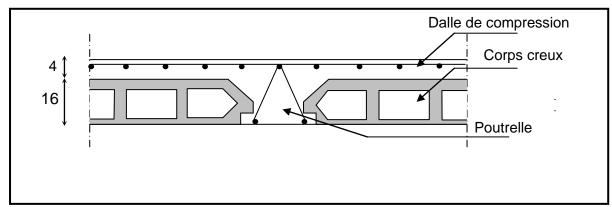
Coupe transversale d'un plancher à corps creux
